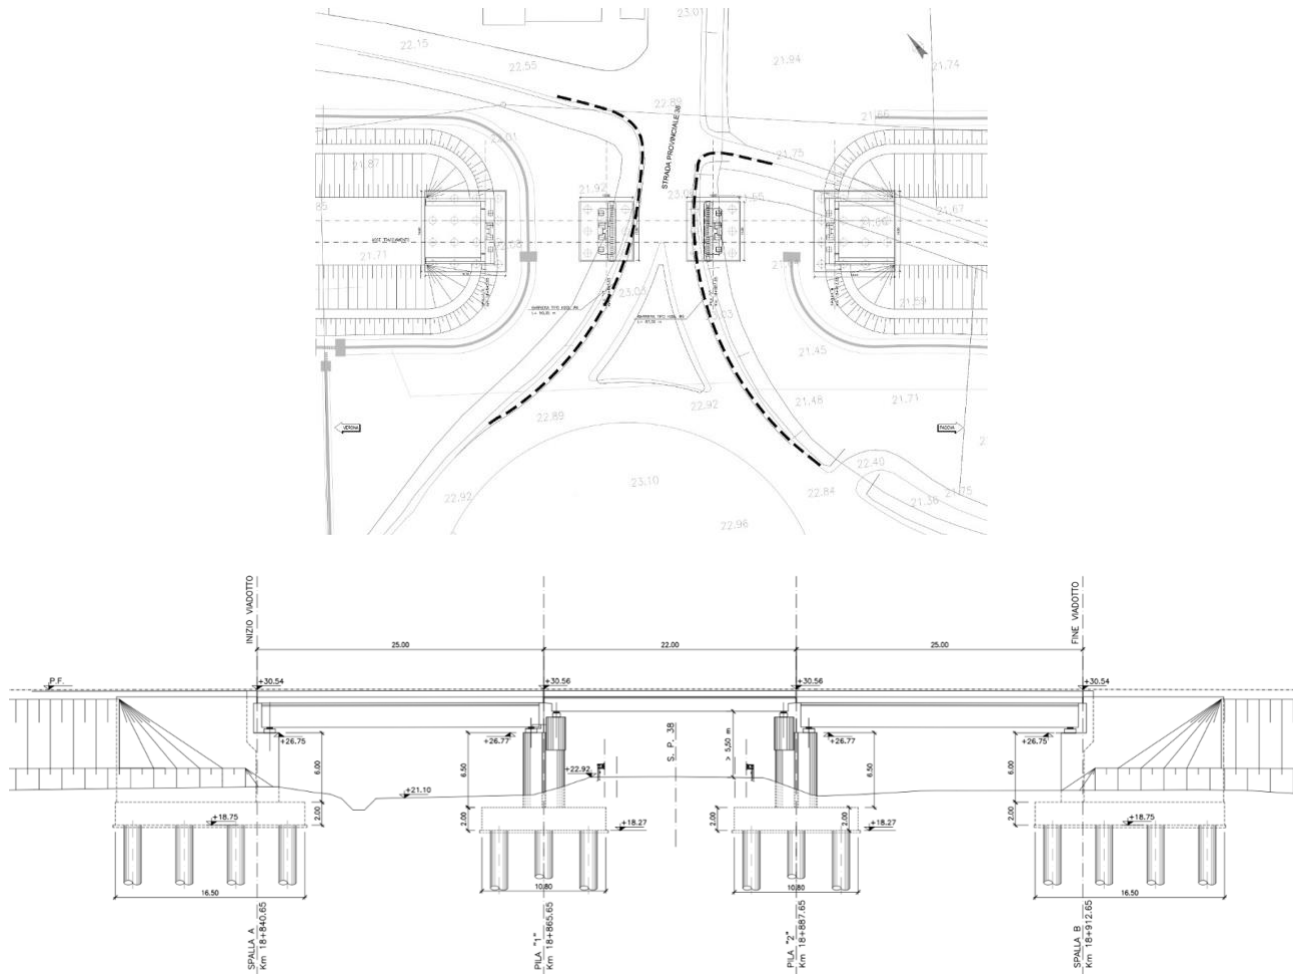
Variante PR.29 – Planimetria e profilo longitudinale del nuovo viadotto Grena
